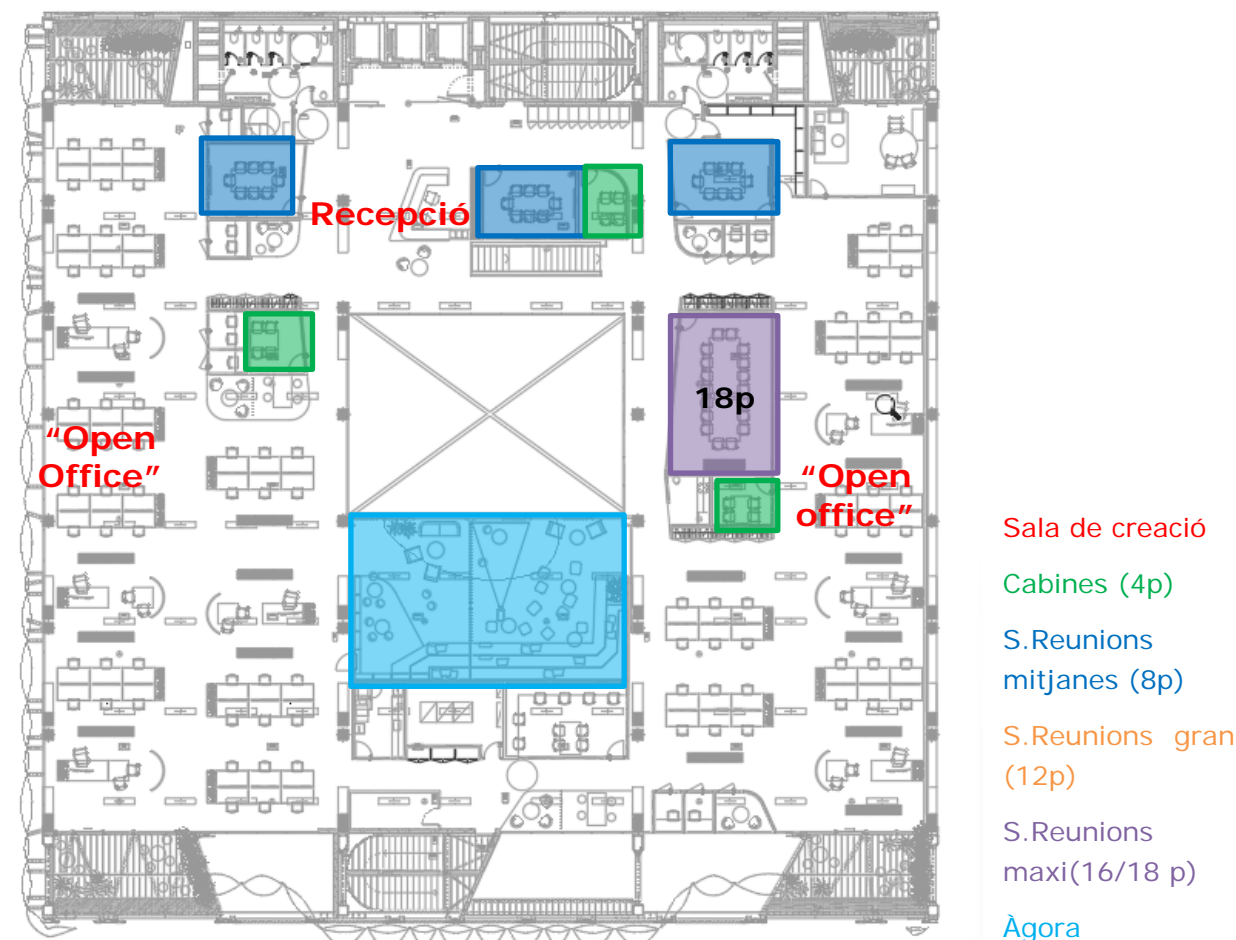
Ubicació dels espais estudiats a la planta 8
